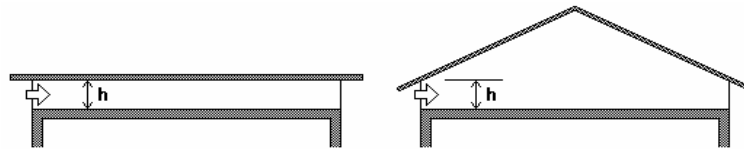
Aberturas (h) em beirais, para ventilação do ático.
